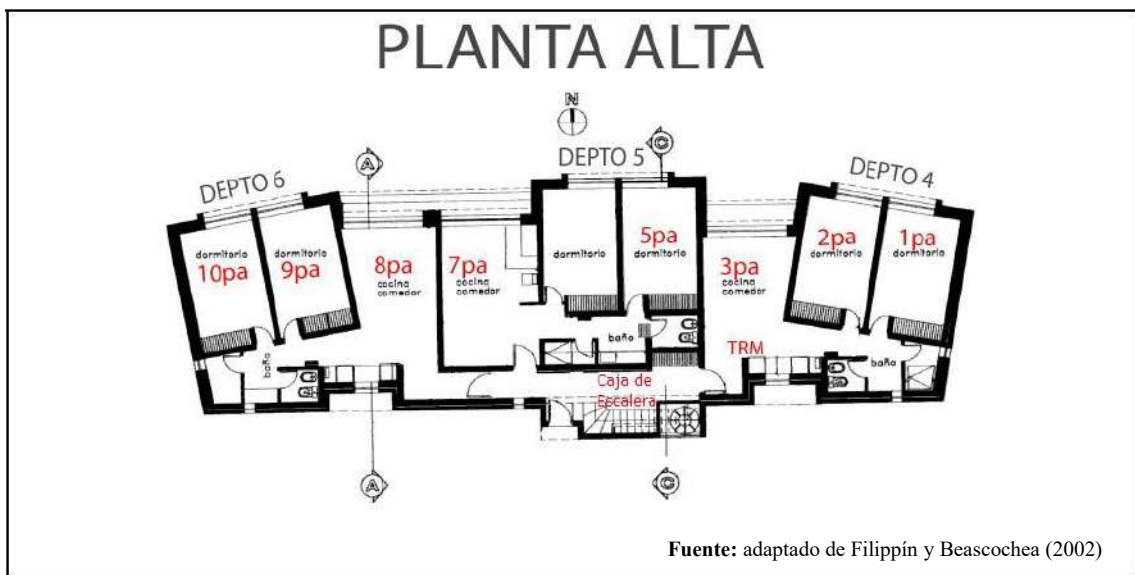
Disposición de los sensores en los departamentos de planta alta
